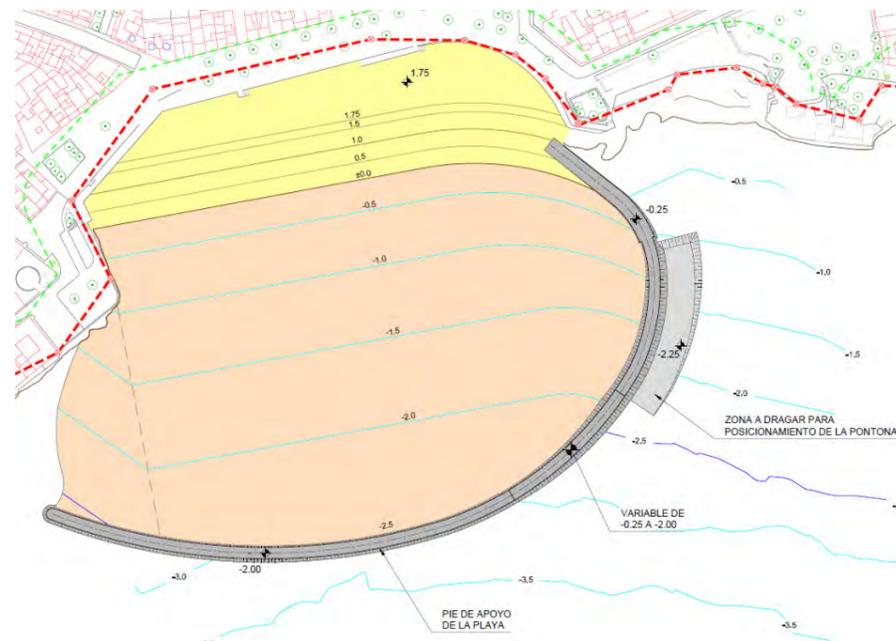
Planta de las obras (Fuente: elaboración propia)
